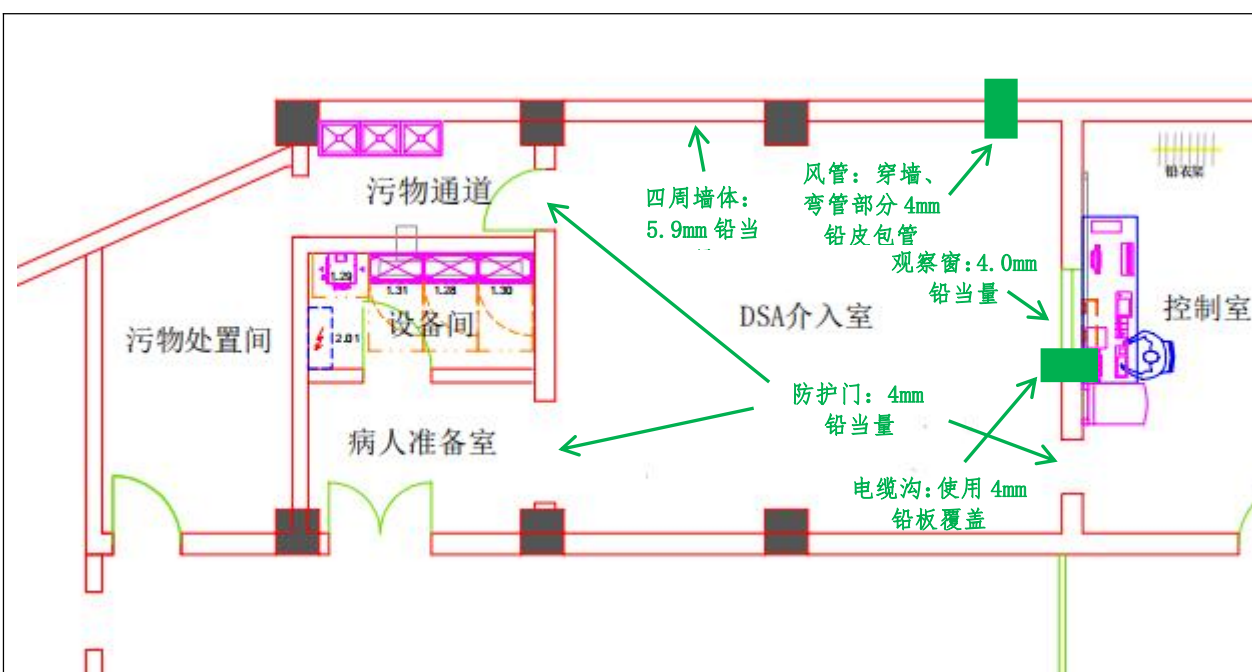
本项目 DSA 介入室屏蔽防护设计平面图
